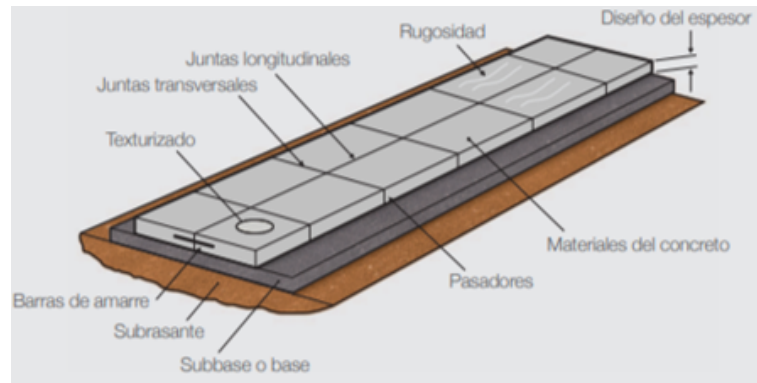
Elementos de pavimento de concreto simple con juntas (American Concrete Pavement Association – ACPA)
